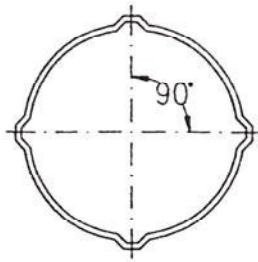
SEZIONE DI UN TUBO INCLINOMETRICO
